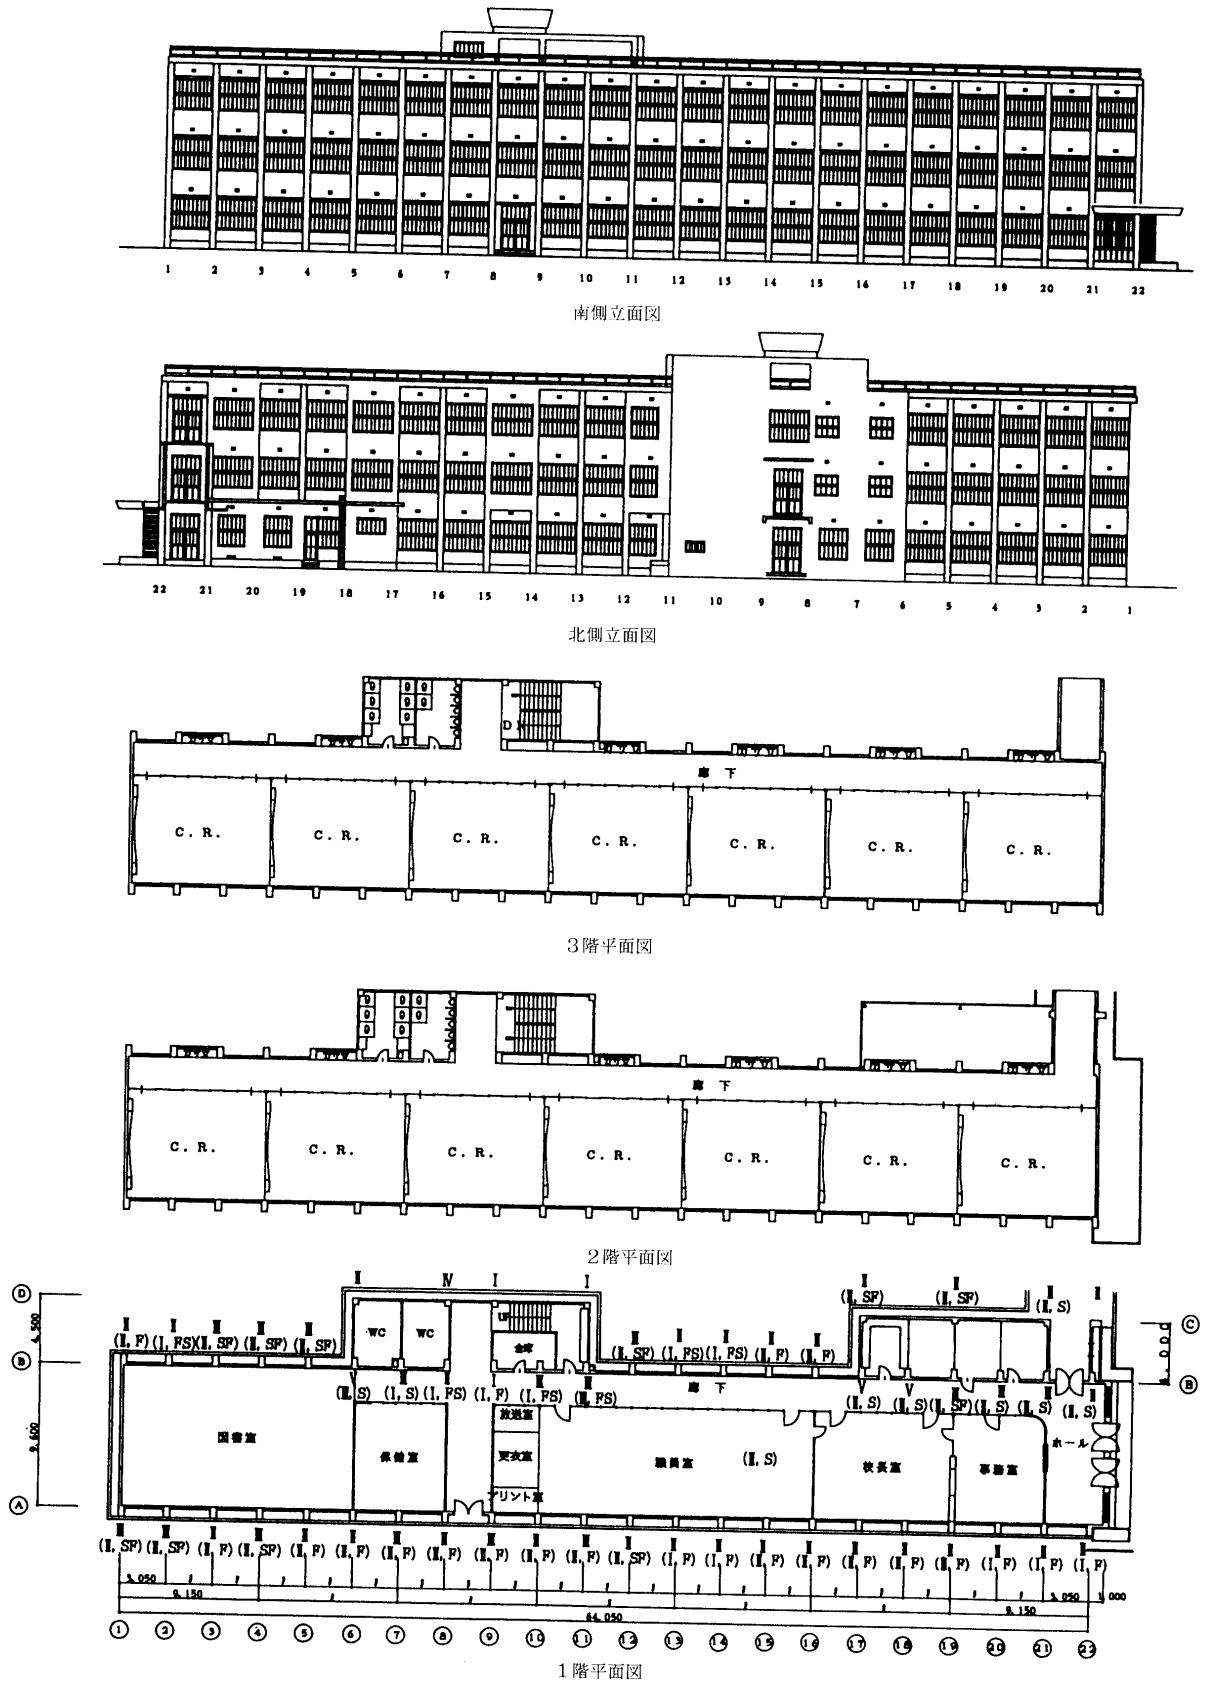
管理教室棟一階二階三階平面図および南北立面図
